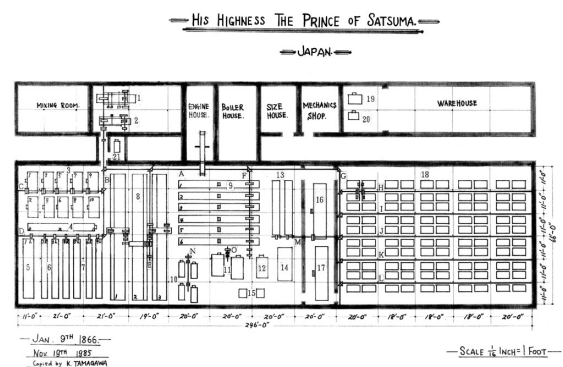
鹿児島紡績所機械配置平面図(玉川寛治氏作成)
